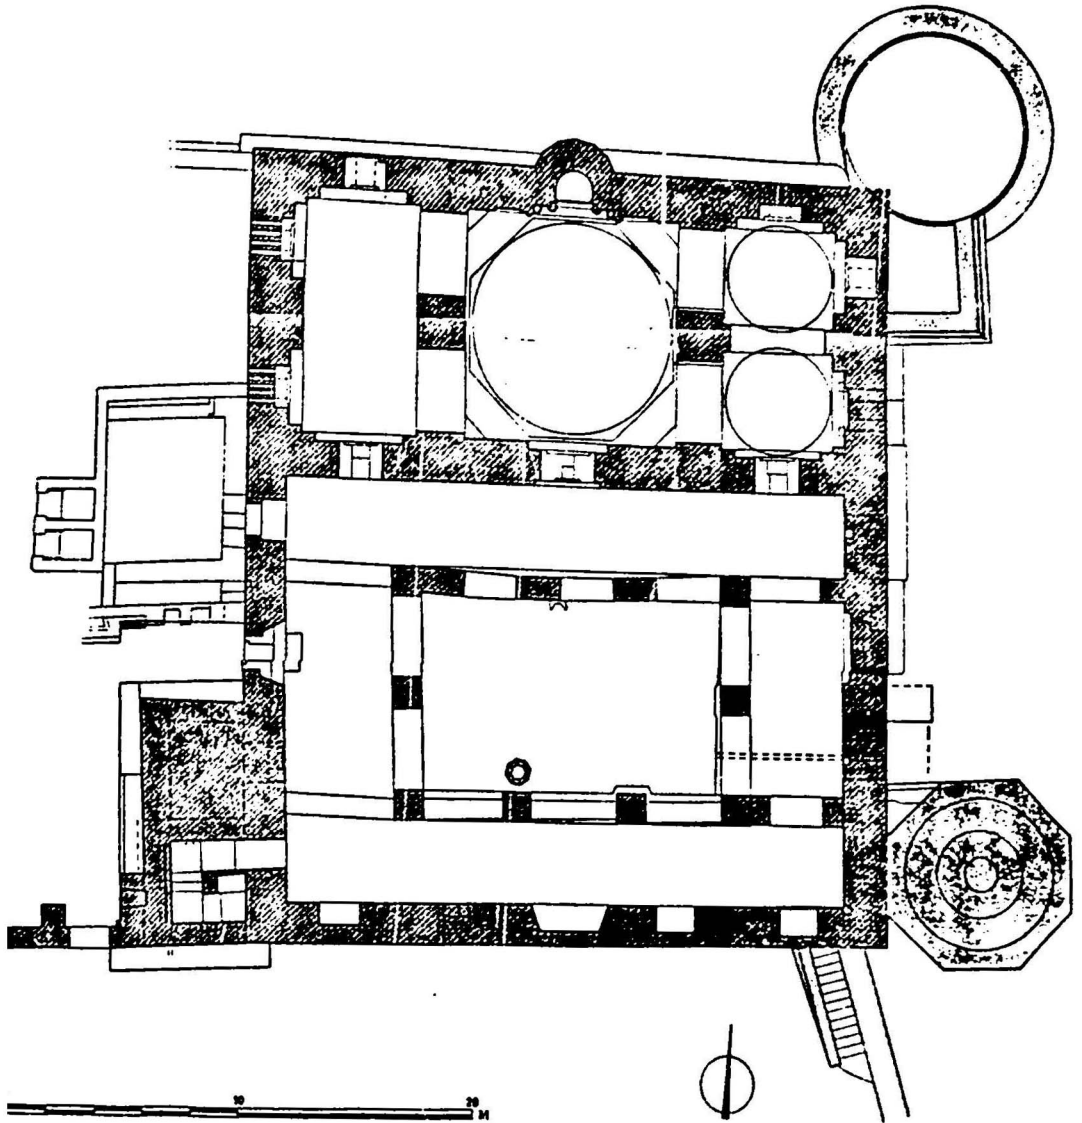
مسقط أفقي للمدرسة العامرية - رداق - الطابق الأول
